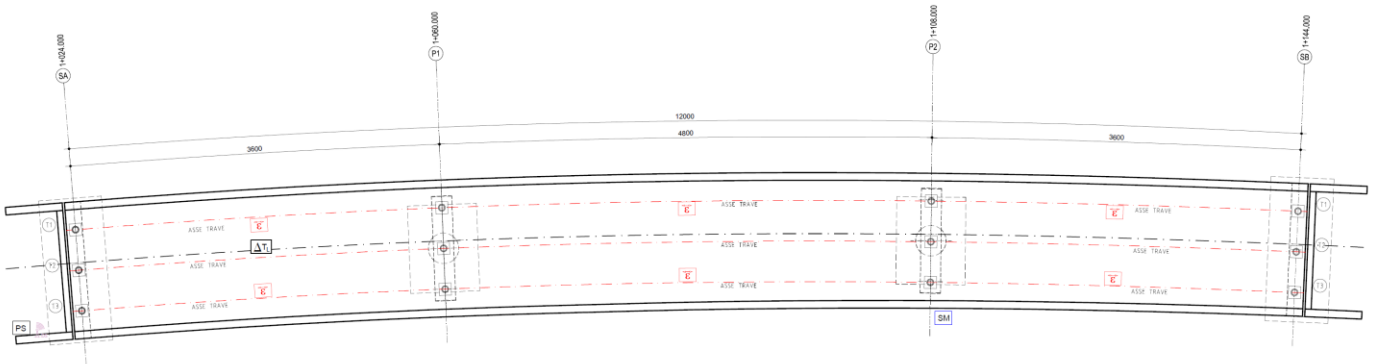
Ubicazione sensori su impalcato (Pianta impalcato S. Antonio)
